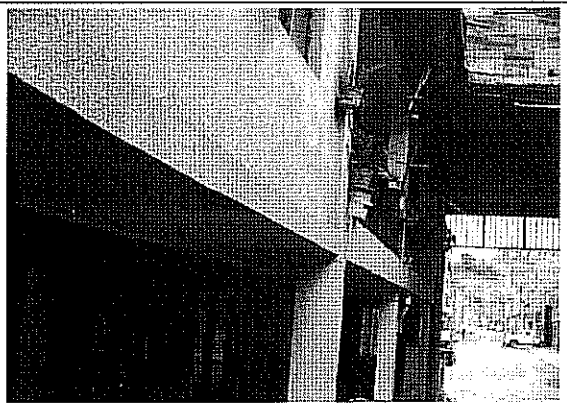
Placa de entrepiso de la zona posterior en buen estado.
